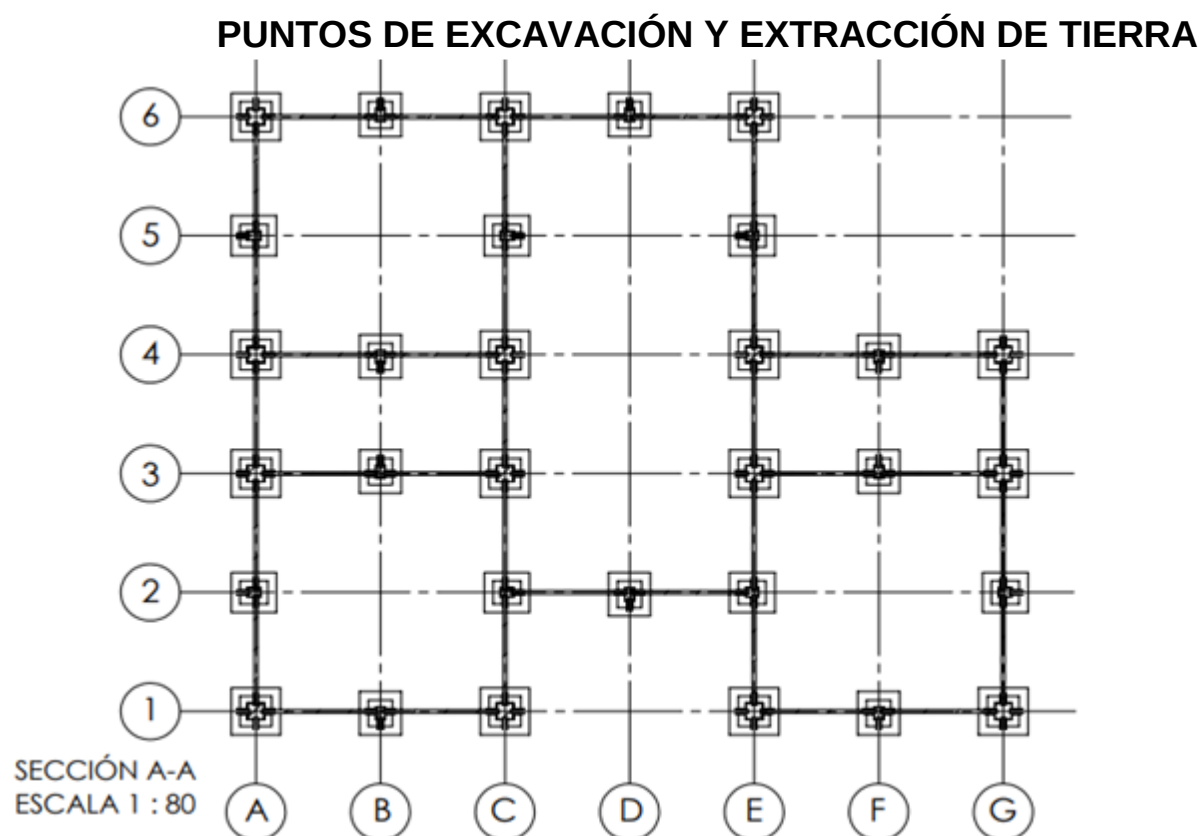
Puntos de excavación y extracción de tierra del “Proyecto Vivir”. Fuente: PREMOLDEADOS SAS, 2024
